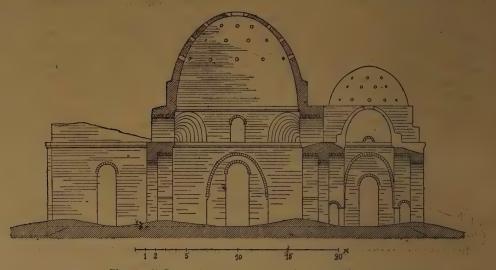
Coupe du palais sassanide de Sarvistan.
